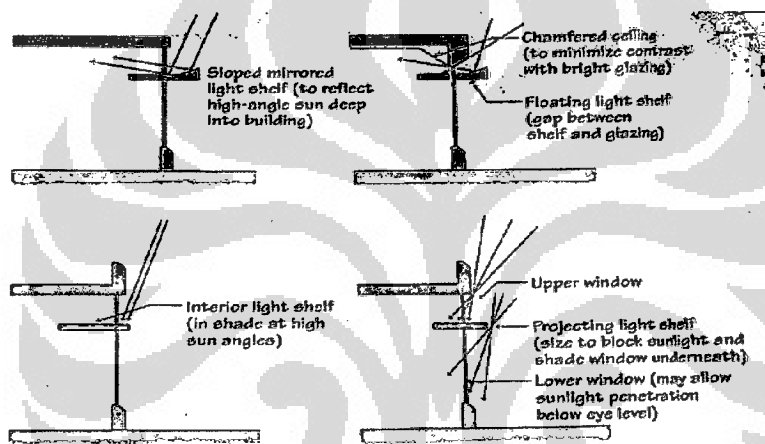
Light Shelves pada Eksterior Bangunan
